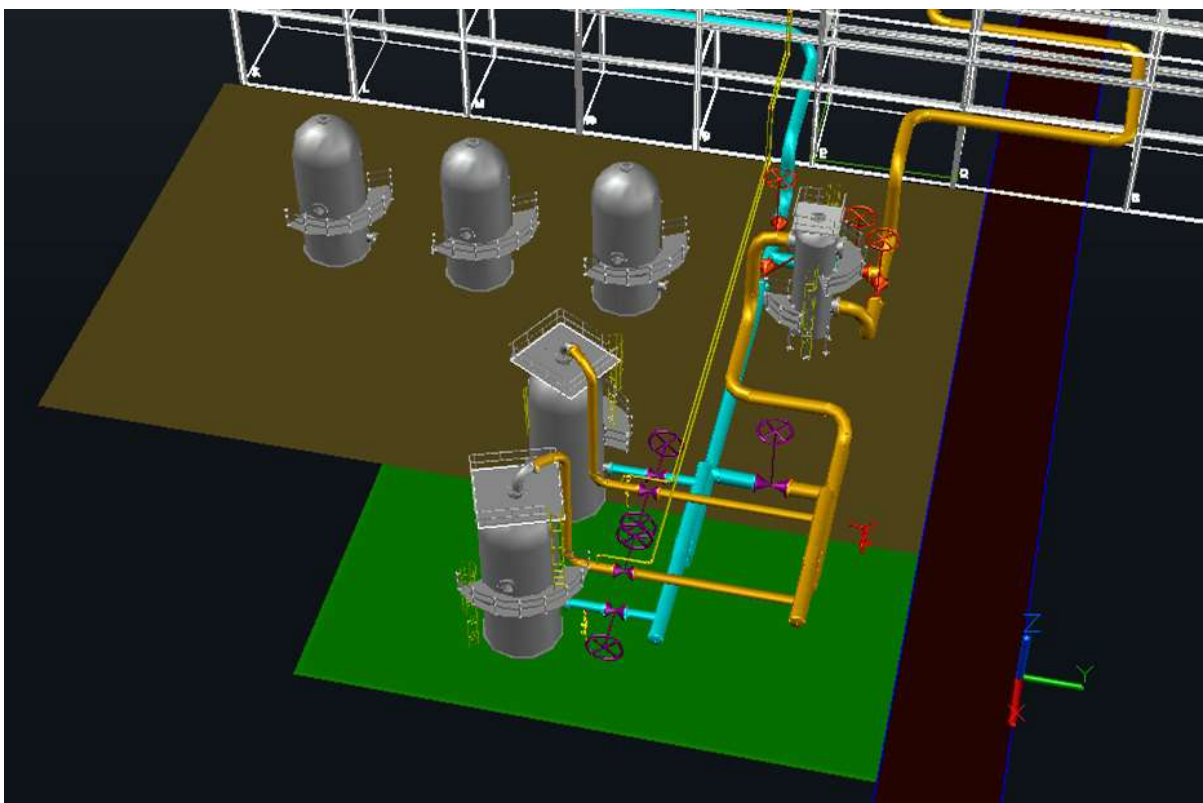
Ampliación de pavimento rígido - Maqueta 3D - PSLCV
